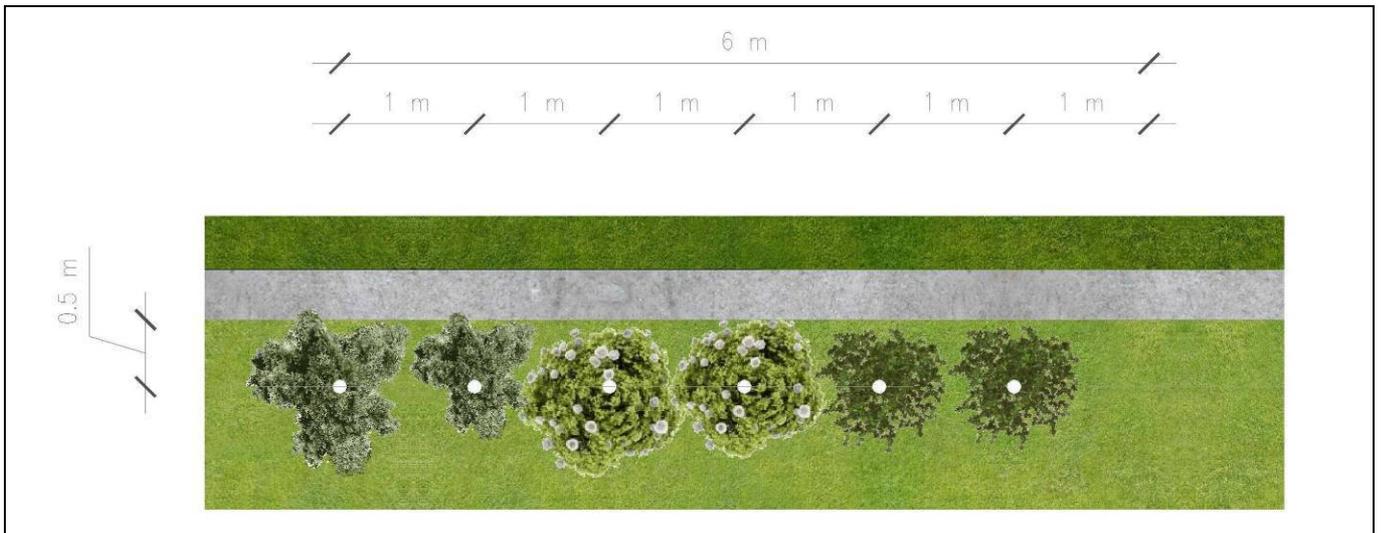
Prospetto tipo per il filare di rampicanti lungo i muri di sostegno.
